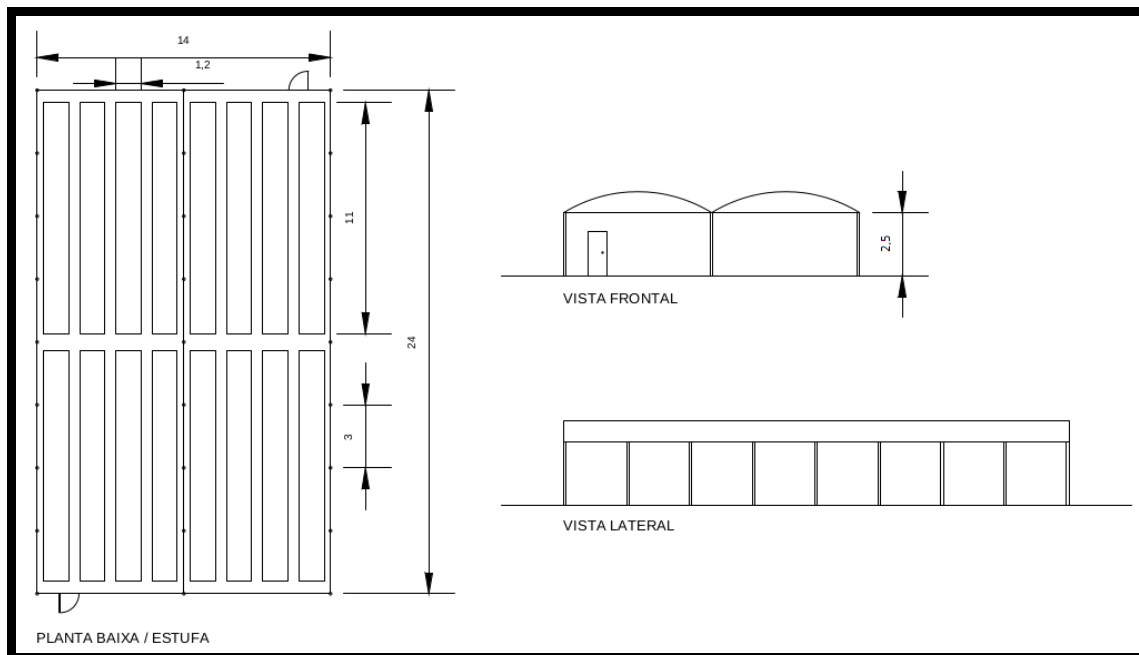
Planta baixa da estufa agrícola e vistas frontal e lateral, cotas em metros.
